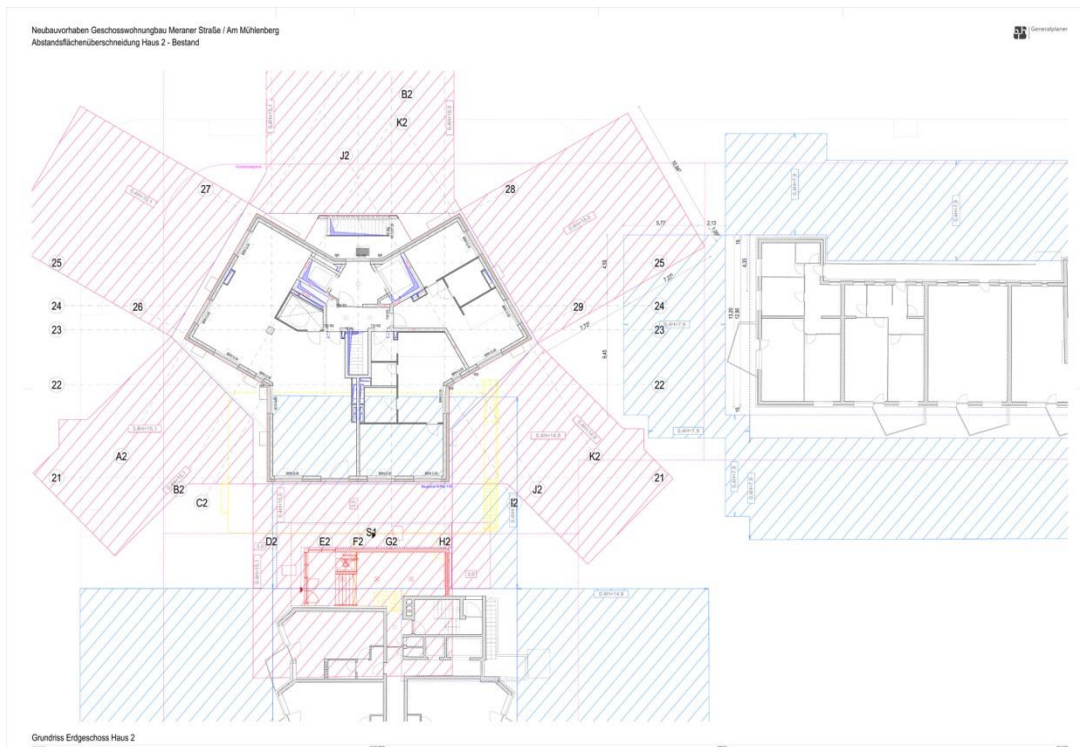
Überlagerung der Abstandsflächen der Baukörperausweisung für das nördliche Hochhaus mit den Abstandsflächen des Gebäudes Am Mühlenberg 4
